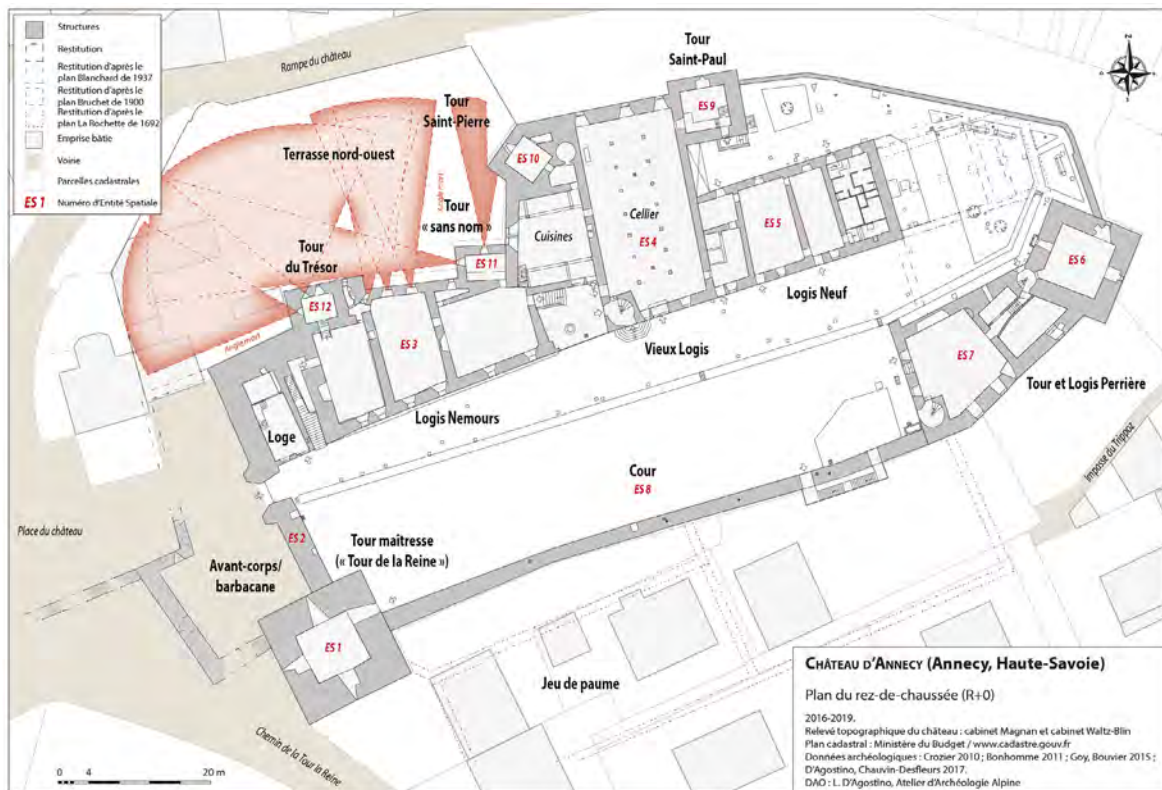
Château d'Annecy. Plan de tir des canonnières du rez-de-chaussée du château (angle nord-ouest). Doc. : L. D'Agostino.
